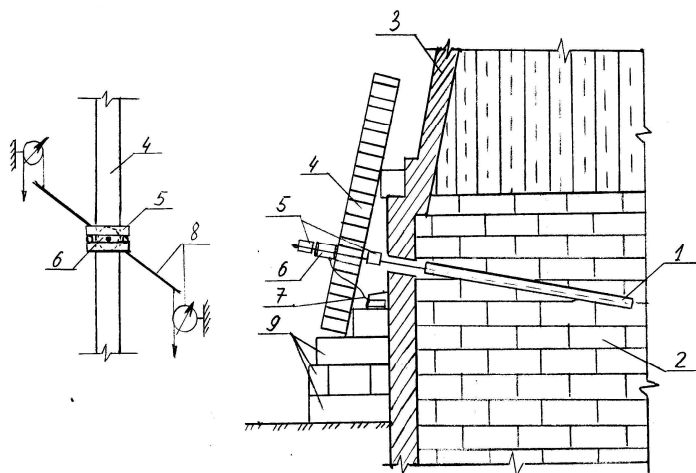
Схема испытания сваи-анкера на выдергивание: 1 — свая-анкер с центральным арматурным стержнем; 2 — известняк-ракушечник; 3 — железобетонная, подпорная стенка; 4 — стальная опорная балка; 5 — стальная серьга; 6 — домкрат; 7 — насосная станция; 8 — реперная система с прогибомерами; 9 — бетонные блоки
